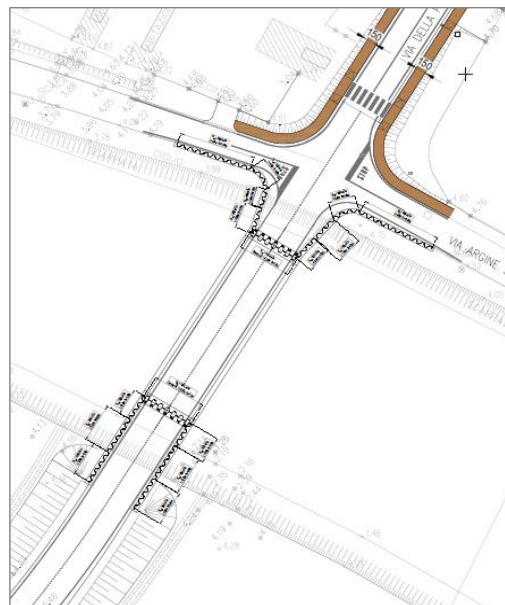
Planimetria ponte provvisorio da convertire nella passerella di accesso all'isola
